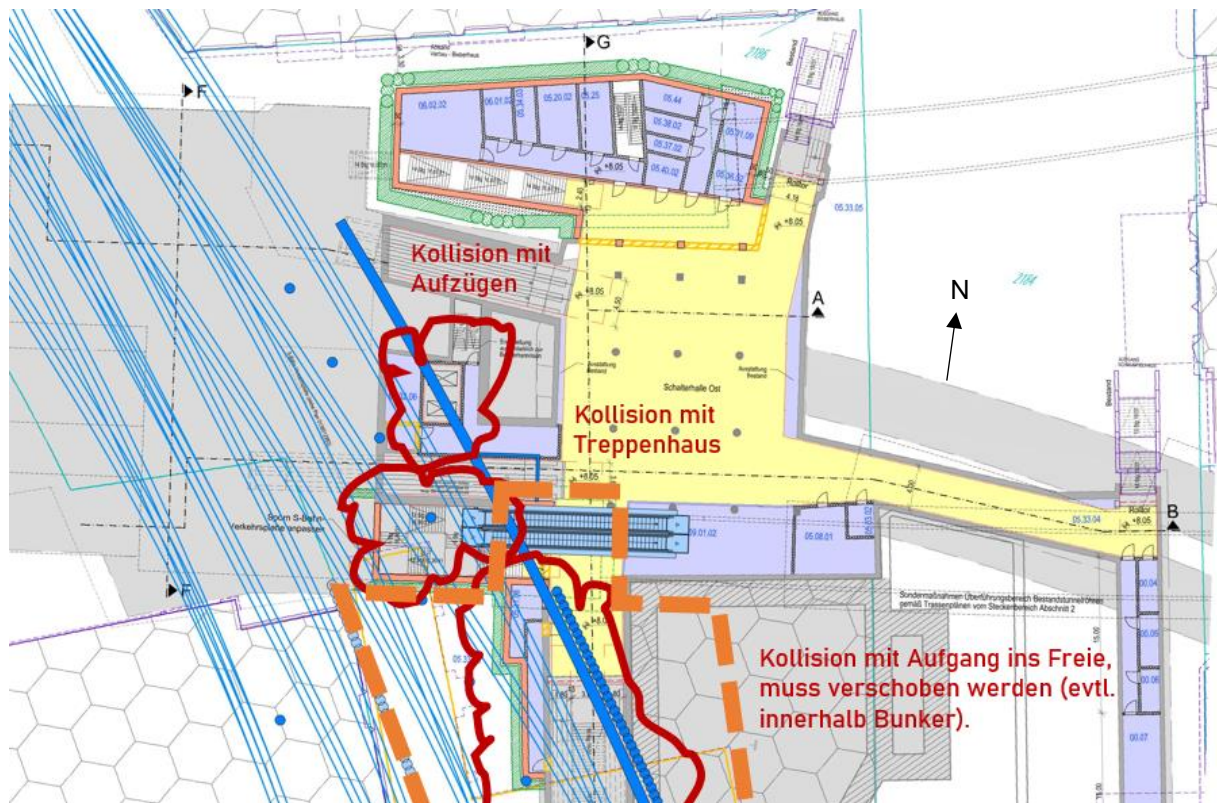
Hbf, Schnittstellen VET mit U5 Hbf Ostkopf, Grundriss Schalterhalle E-1 [U9]
